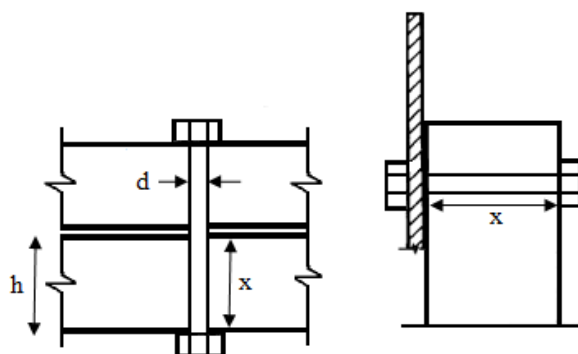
Fixação de peças de madeira e metálica utilizando parafuso
